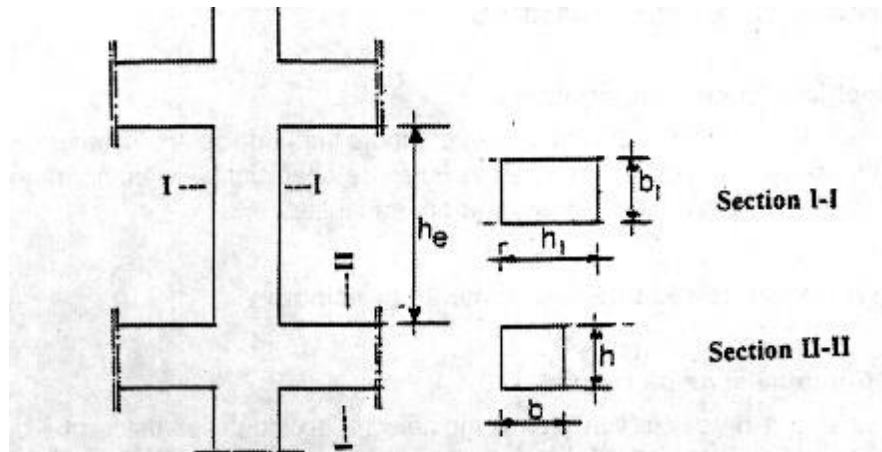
Coffrage des poteaux. (Art, 7.4.1, P61, RPA99/2003).
